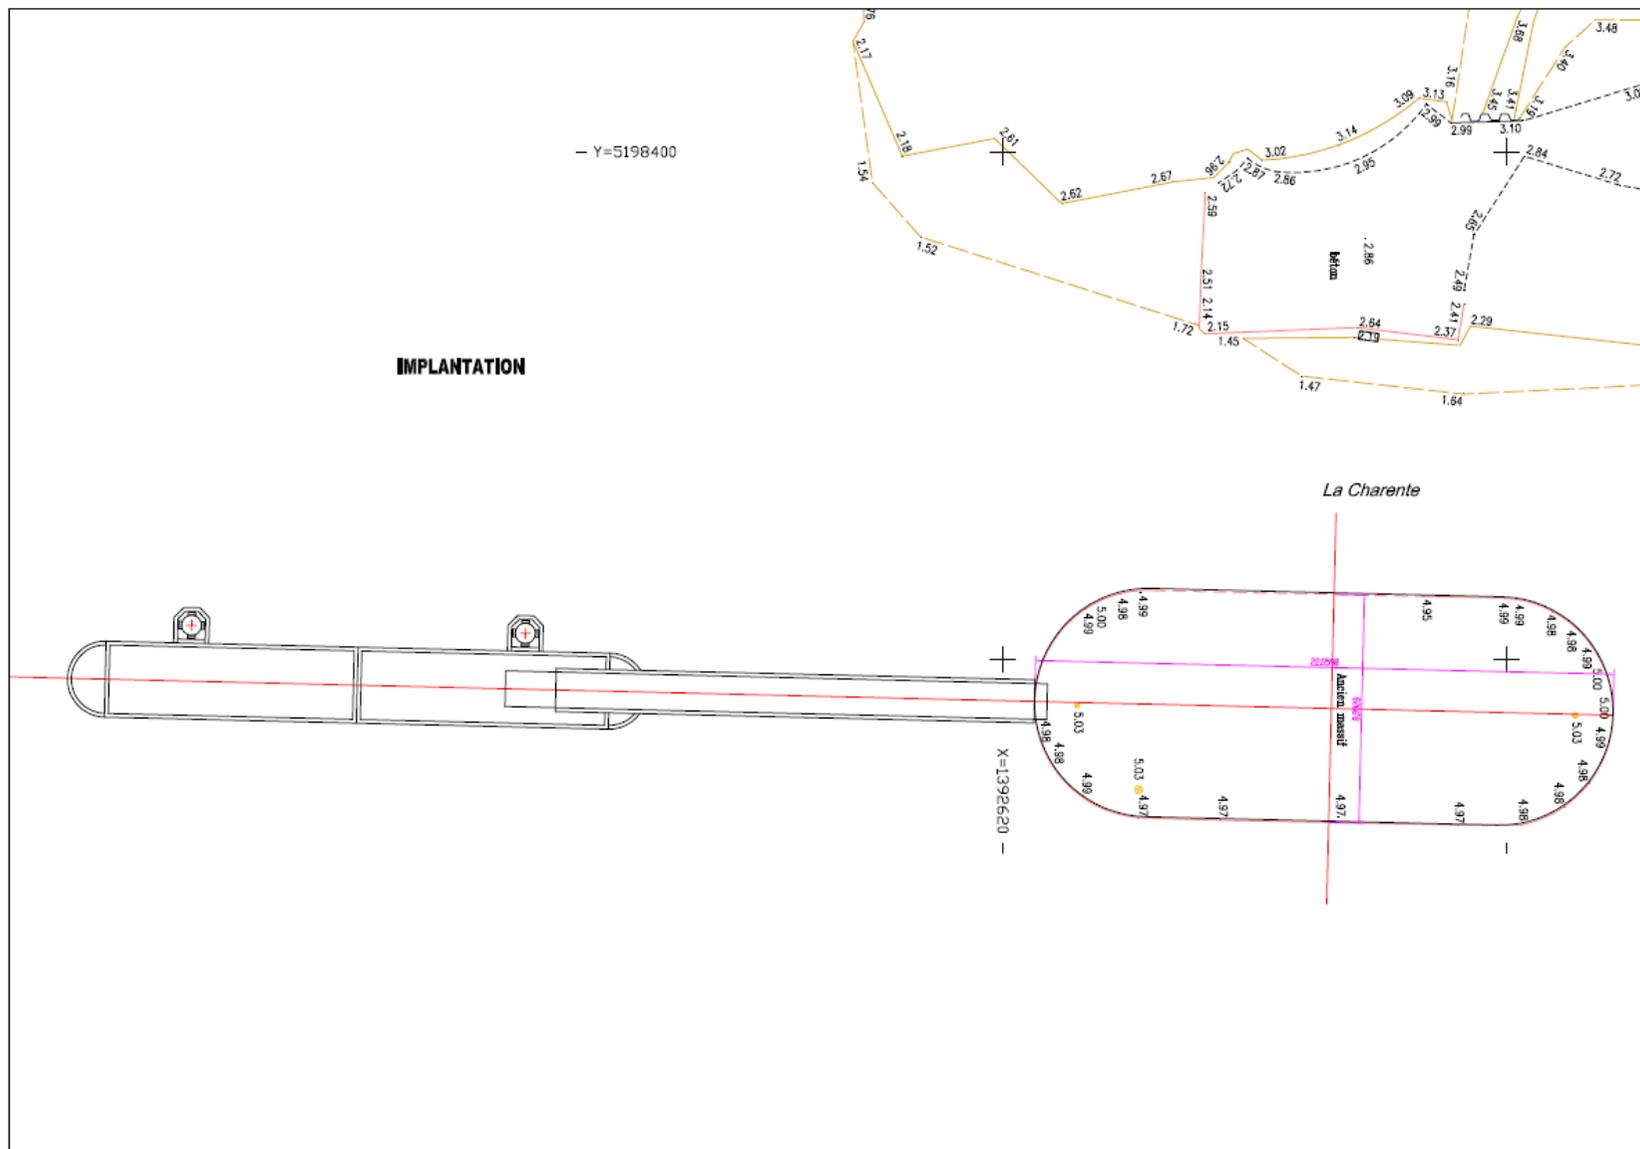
Plan en vue de dessus du ponton d'accostage rive droite - Source EGCA
